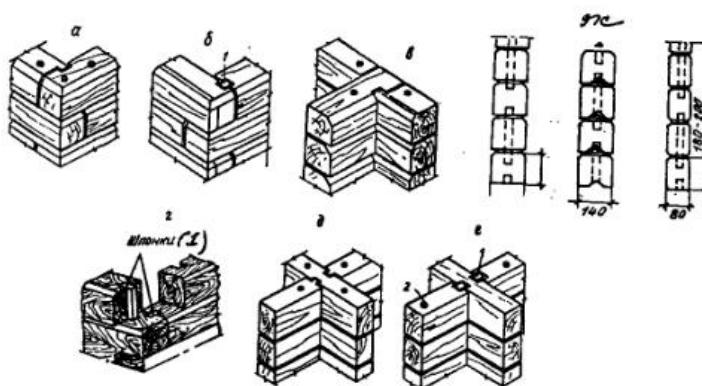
Стены деревянные брусковые: а — угловое соединение на шипах; б — угловое соединение на шпонках; в — сопряжение внутренней стены с наружной на шипах; г — сопряжение внутренней стены с наружной на шпонках; д — пересечение стен на шипах; е — пересечение стен на шпонках; ж — соединение бревна с помощью шпонки. 1 — шпонка сечением 50x50 мм длиной 150 мм; 2 — шип диаметром 30 мм.
